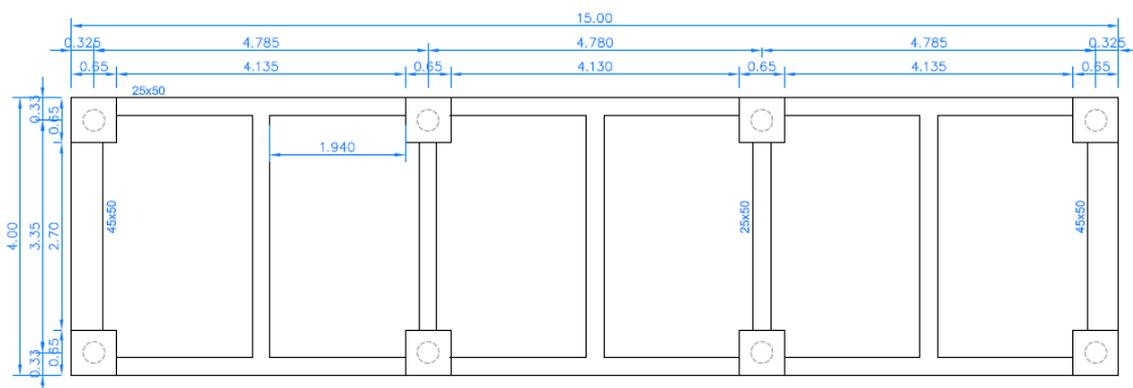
Vue en plan de la structure béton -- source DOE ETPO Guadeloupe juillet 2012
